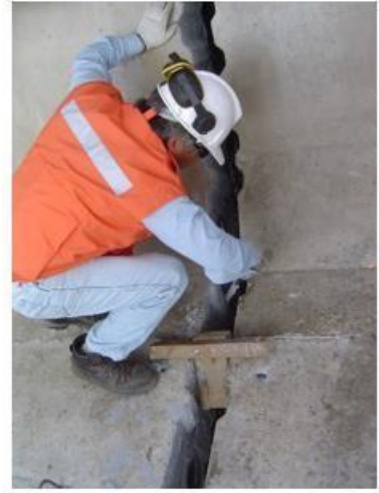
Ensamblaje temporal de dovelas mediante barras de pre esforzado y aplicación de adhesivo epóxico
